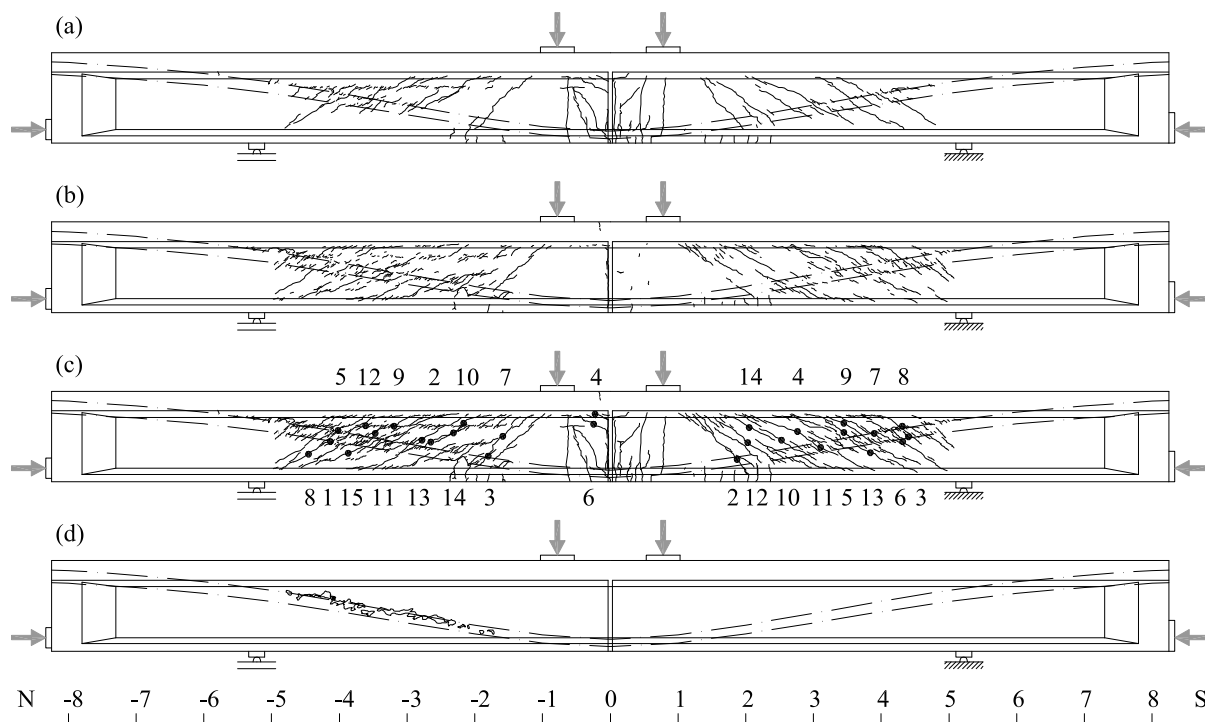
Fissuration de l'essai SH1 : (a) palier 3 (b) fissuration additionnelle entre le palier 3 et la rupture (c) rupture (d) éclatement du béton immédiatement après la rupture
